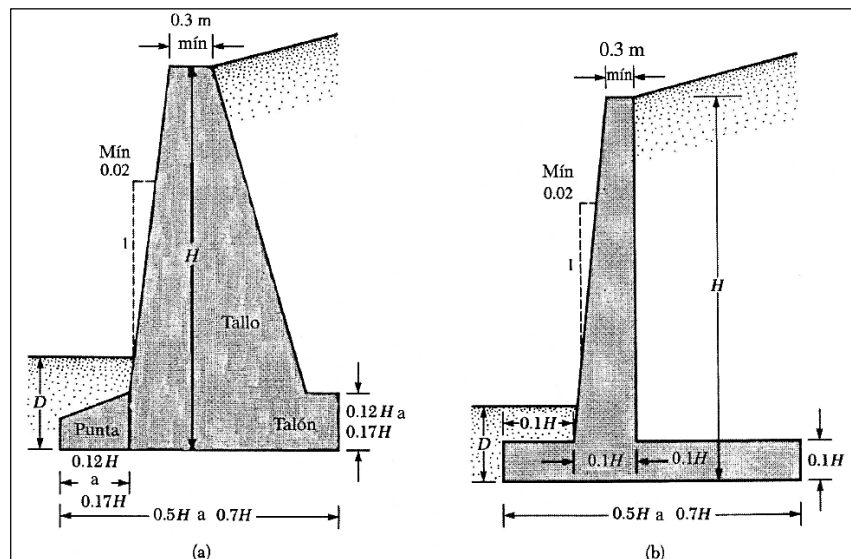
Dimensiones aproximadas para revisiones iniciales de muro de contención, (a) muro por gravedad, (b) muro en voladizo.
